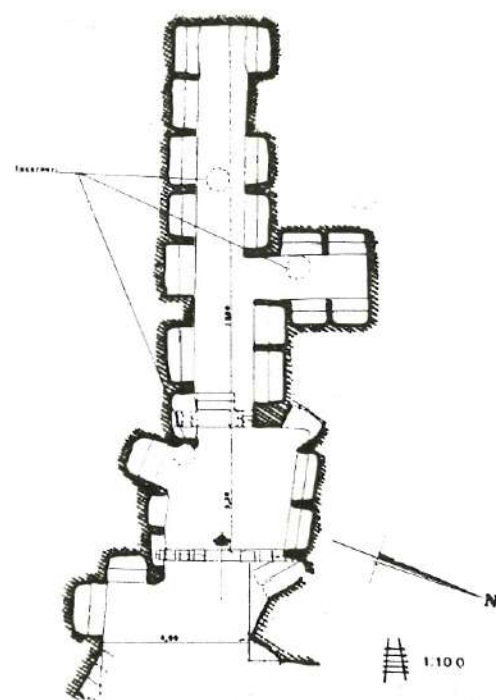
CAPPARELLI: planimetria dell'ipogeo n. 5.
